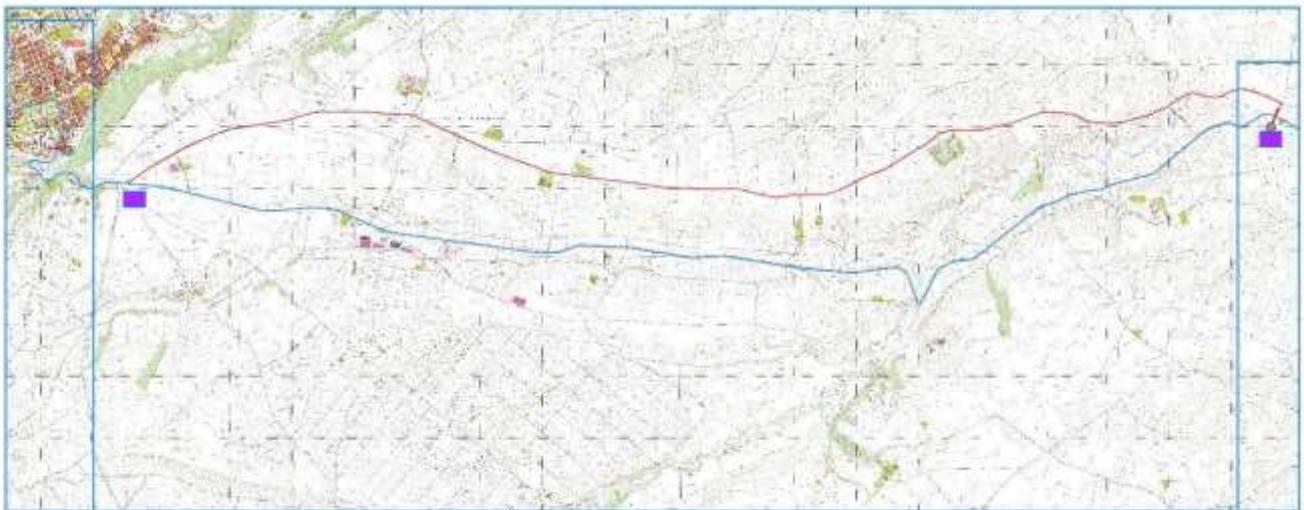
Tracciato planimetrico del Tratto 4.3 della Ciclovía
